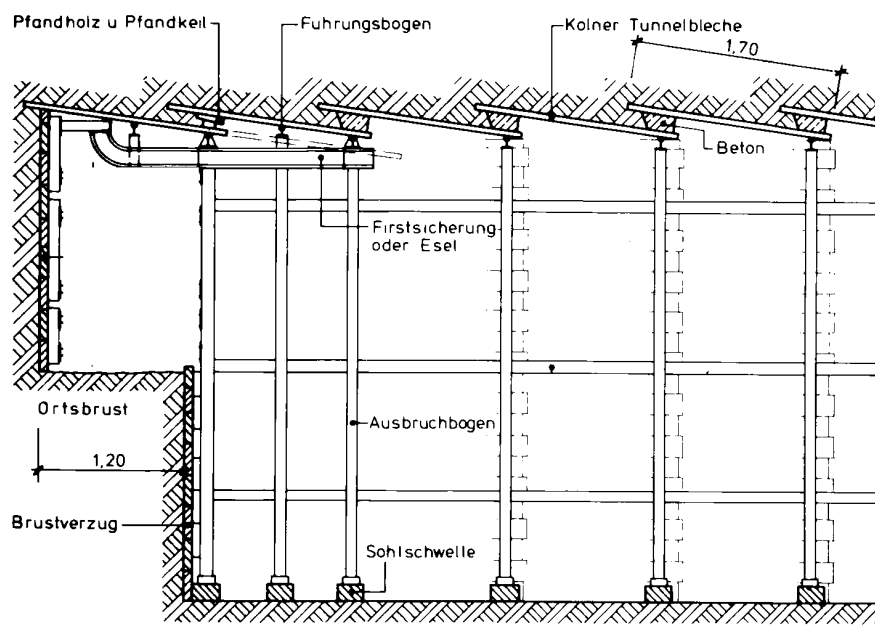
Darstellung Stollenbauweise mit Kölner Verbau
